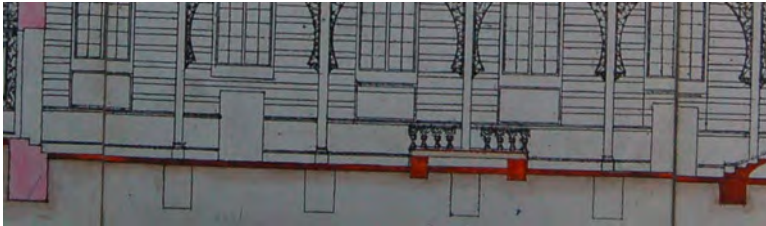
Planmaterial Ausschnitt Längsschnitt; der Schnitt stimmt mit dem Grundriss überein
